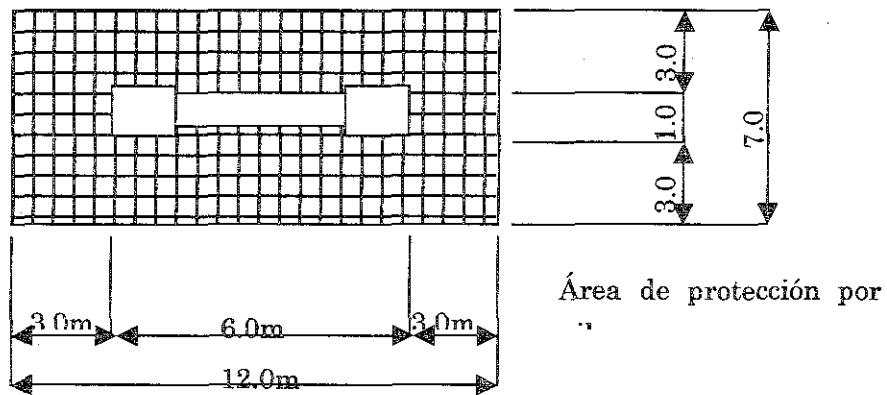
Área de protección de estribo y alrededor de pilar
